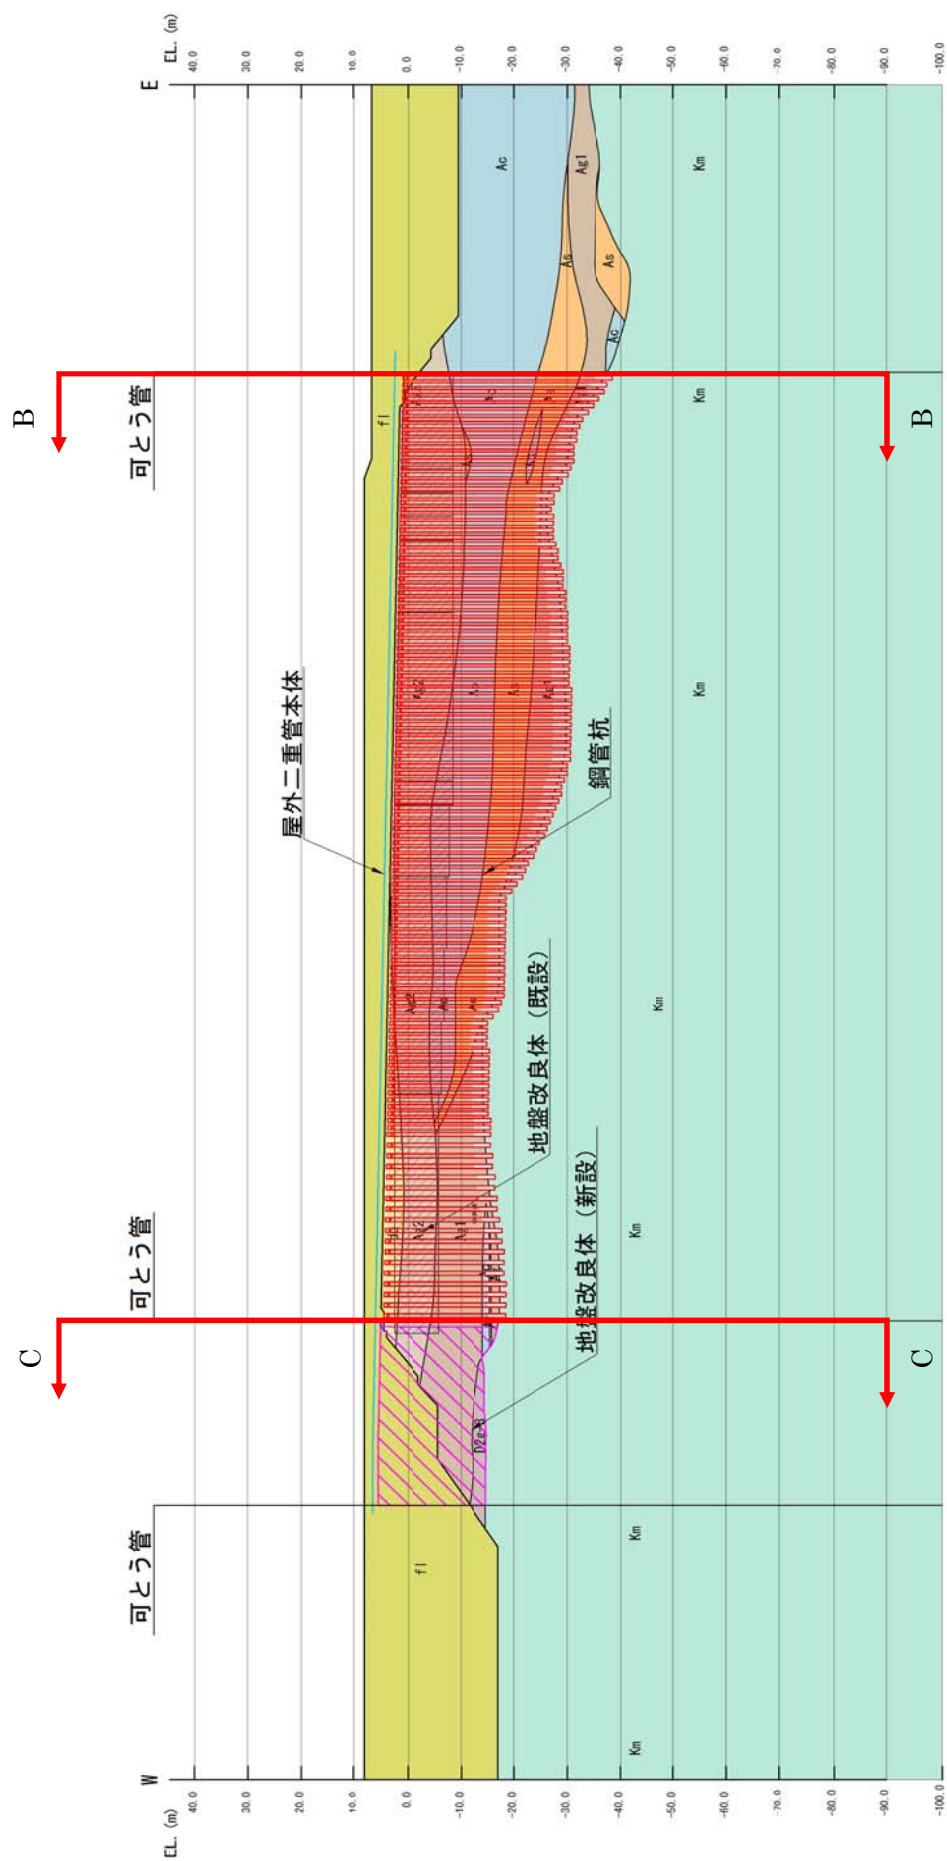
(1) 屋外二重管基礎の評価対象断面図 (A-A 断面)
